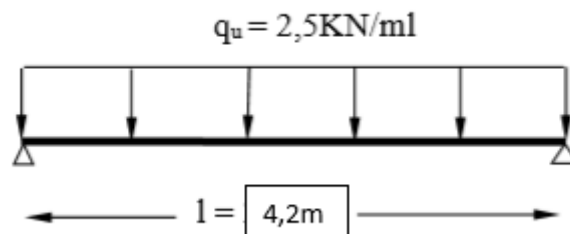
Schéma statique de la poutrelle et son chargement avant coulage de la dalle de compression
